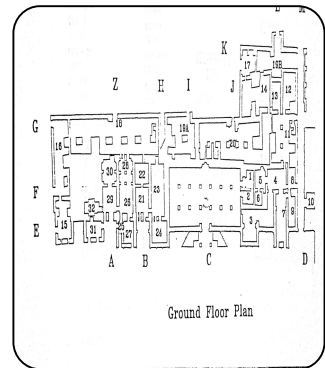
مسقط أفقي للدور الأرضي لمصنع الكسوة
